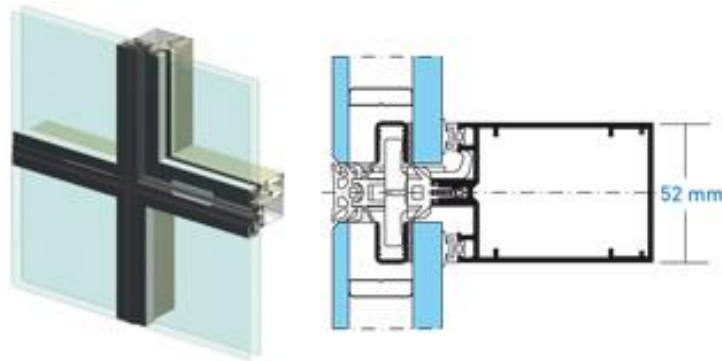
a Sección de perfil de acristalamiento estructural de aluminio.
